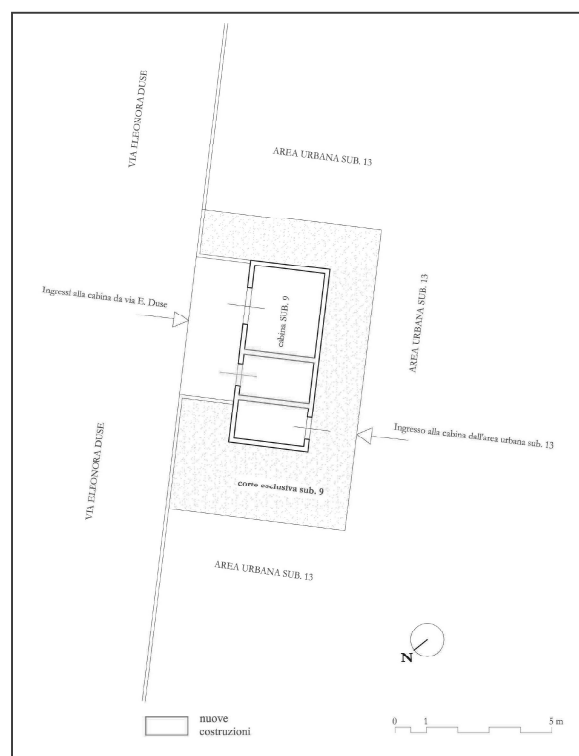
Cabina elettrica sub. 9. Stato di fatto. In rosso è indicata la suddivisione interna non raffigurata nella planimetria catastale
